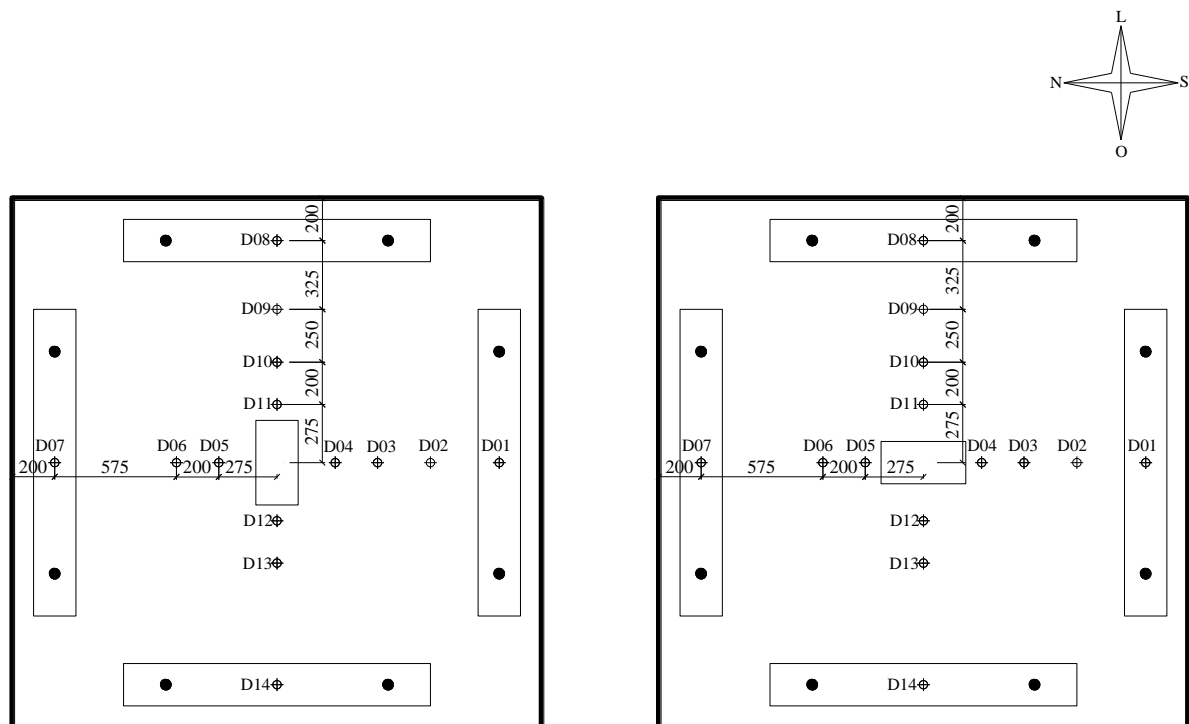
Posição dos extensômetros na face inferior da laje.
